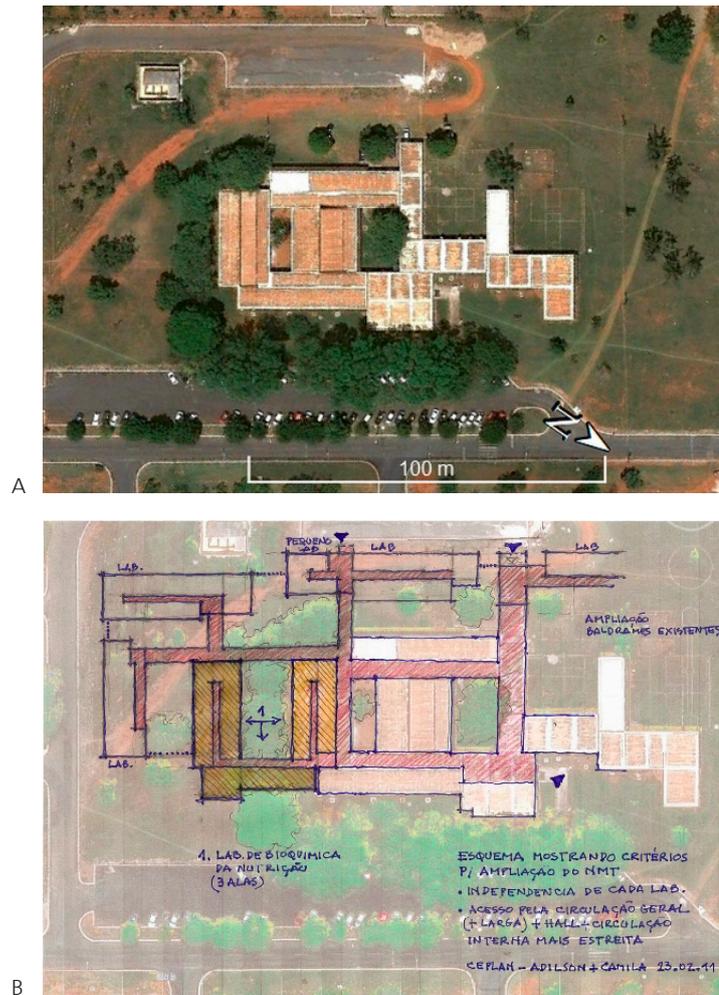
Núcleo de Medicina Tropical, ano 2018. Fonte: Google Earth Pro e croquis do autor com colegas do CEPLAN.
